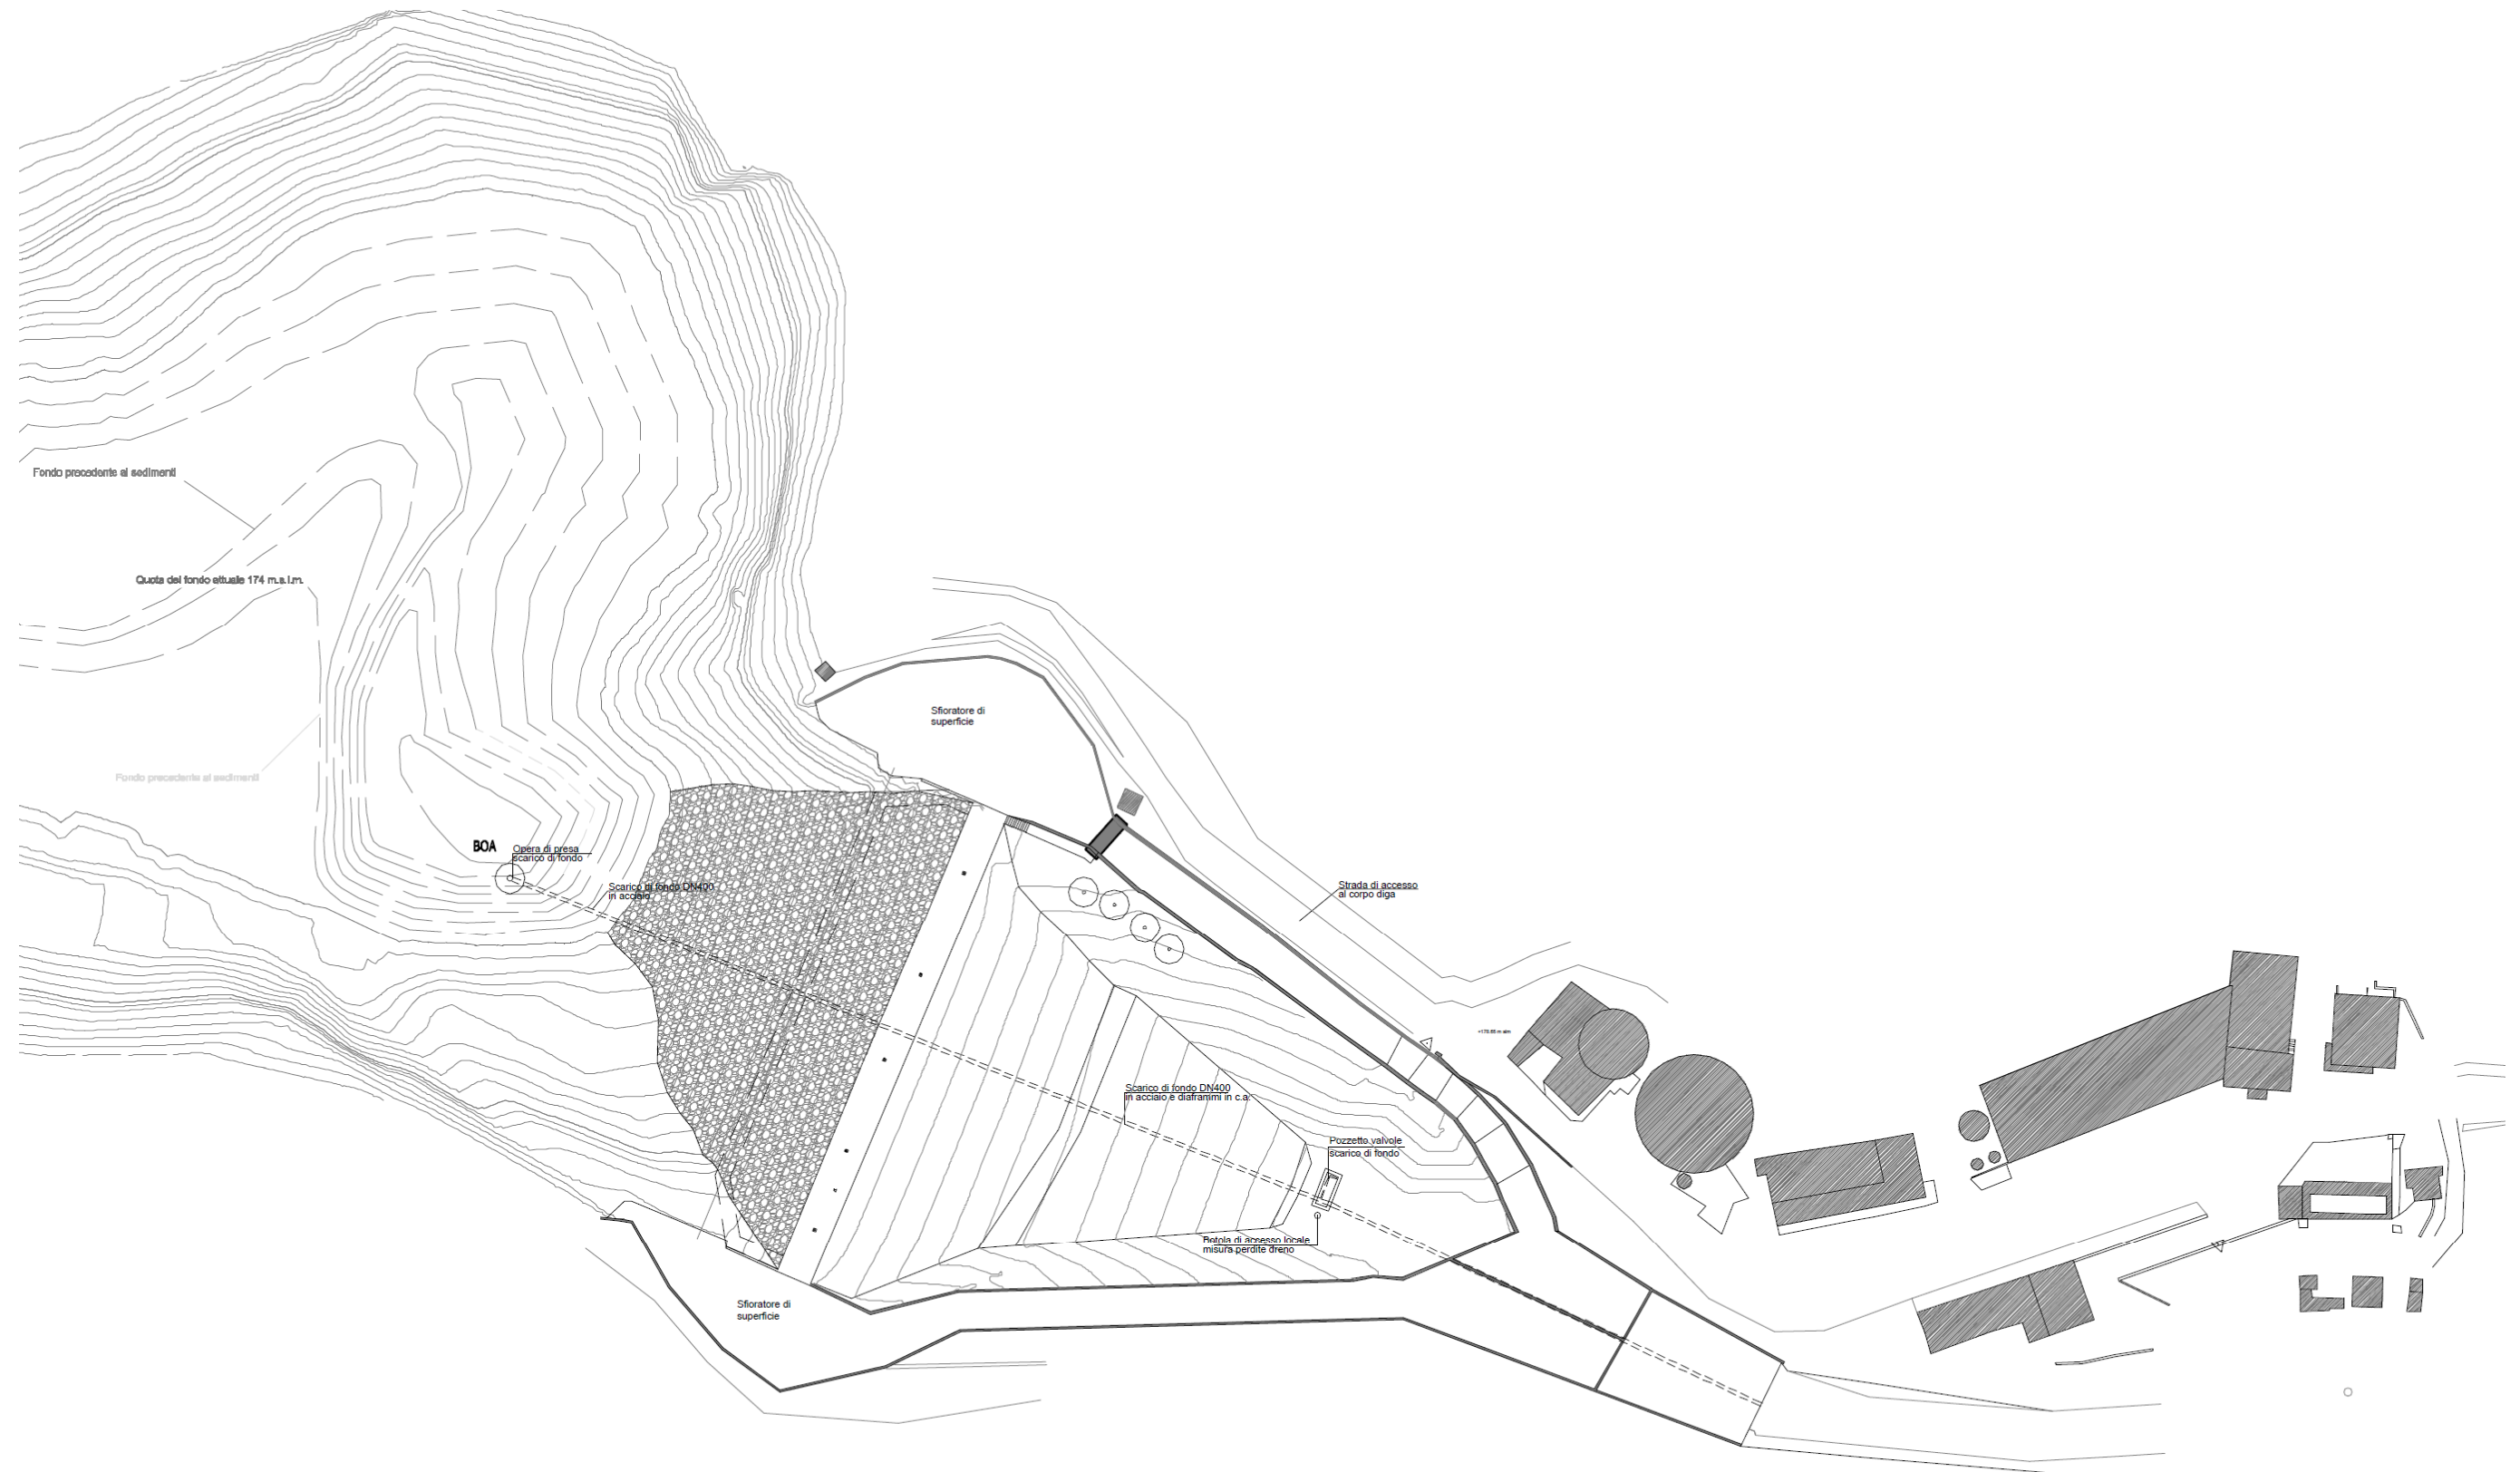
Planimetria della diga Drove di Cepparello allo stato attuale
